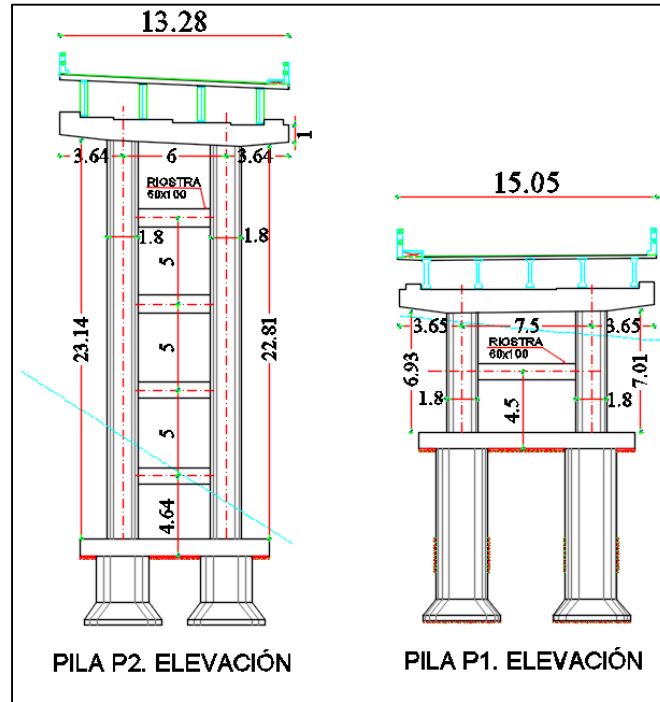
Detalle en elevación Pilas P2 (Tramo A3) y P1 (Tramo A4).
